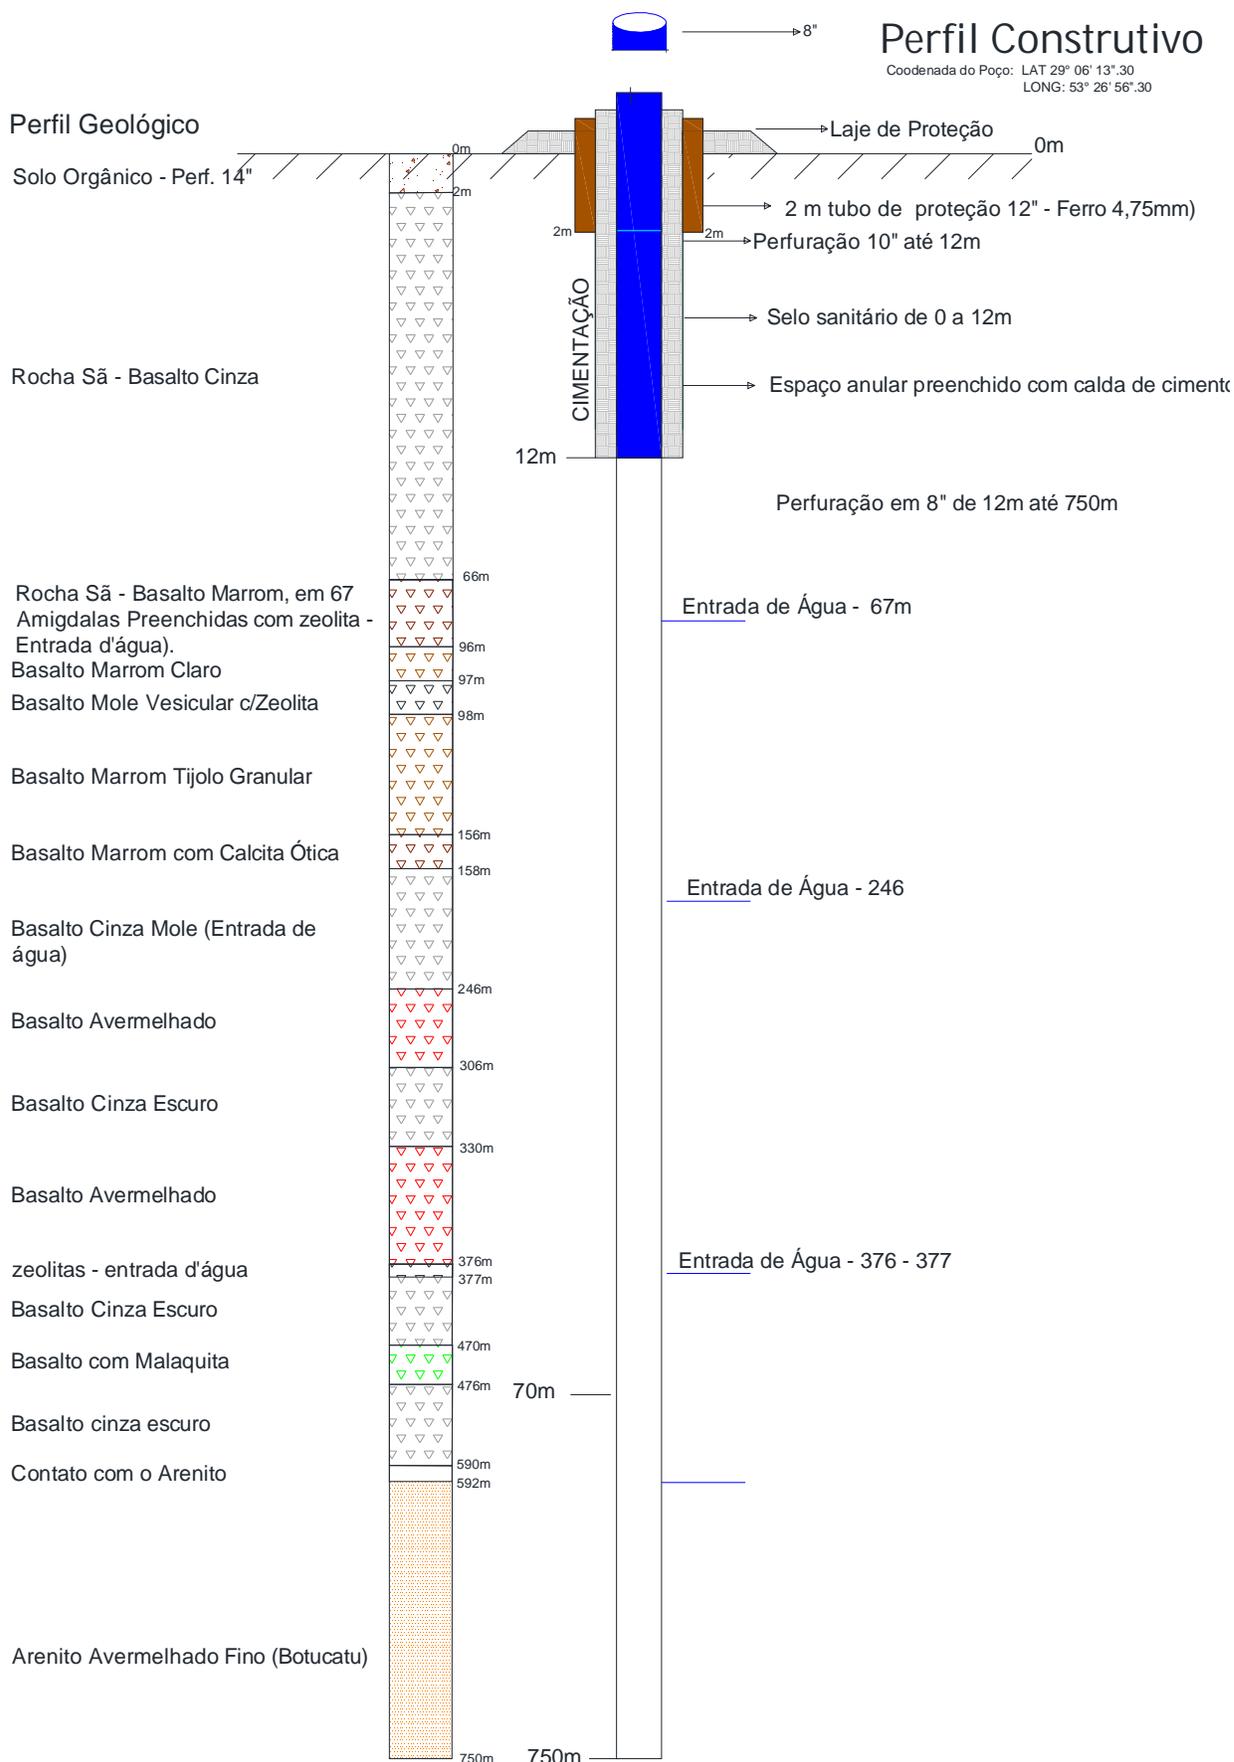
Perfil geológico e Construtivo da Fonte Stefano.
